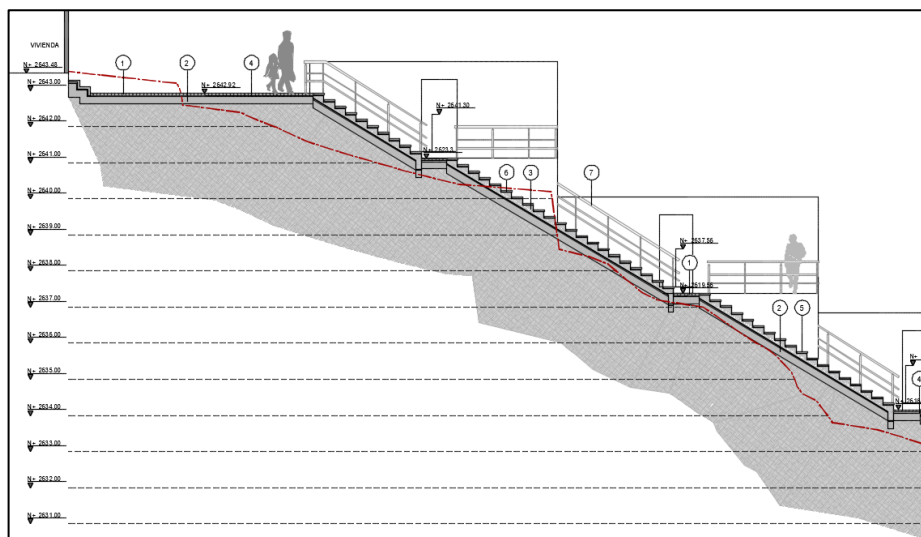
Acercamiento Sección B-B Intersección con Calle 69B
